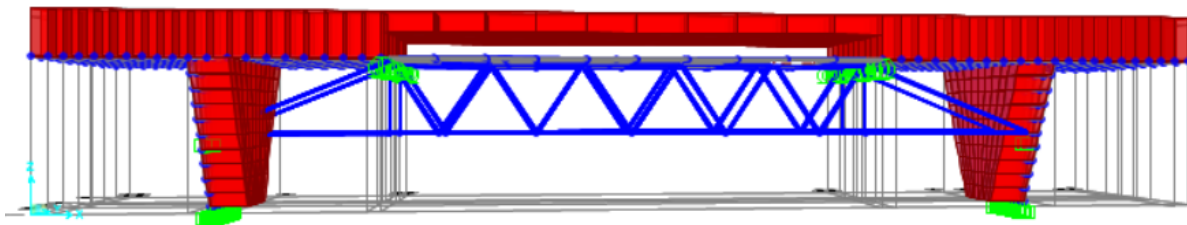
PROPUESTA DE ALTERNATIVA 1 (ARMADURA)
